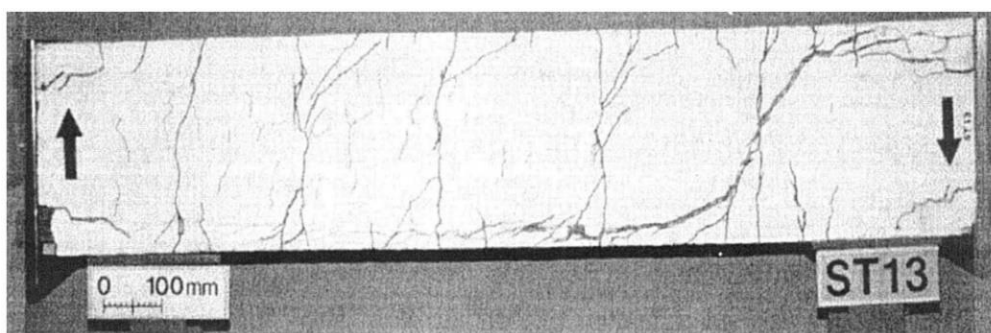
Modèle de fissuration typique : structure sans armature transversale soumise à une traction axiale et cisaillement Adebar et Collins, 1996 [109]
